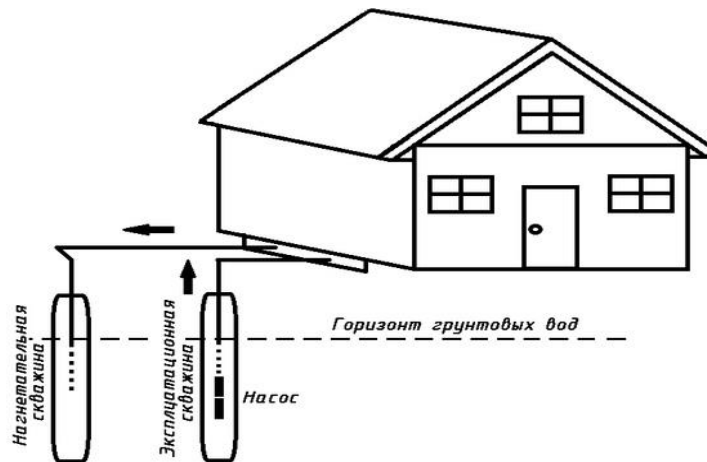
Схема открытой системы использования низкопотенциальной тепловой энергии грунтовых вод
